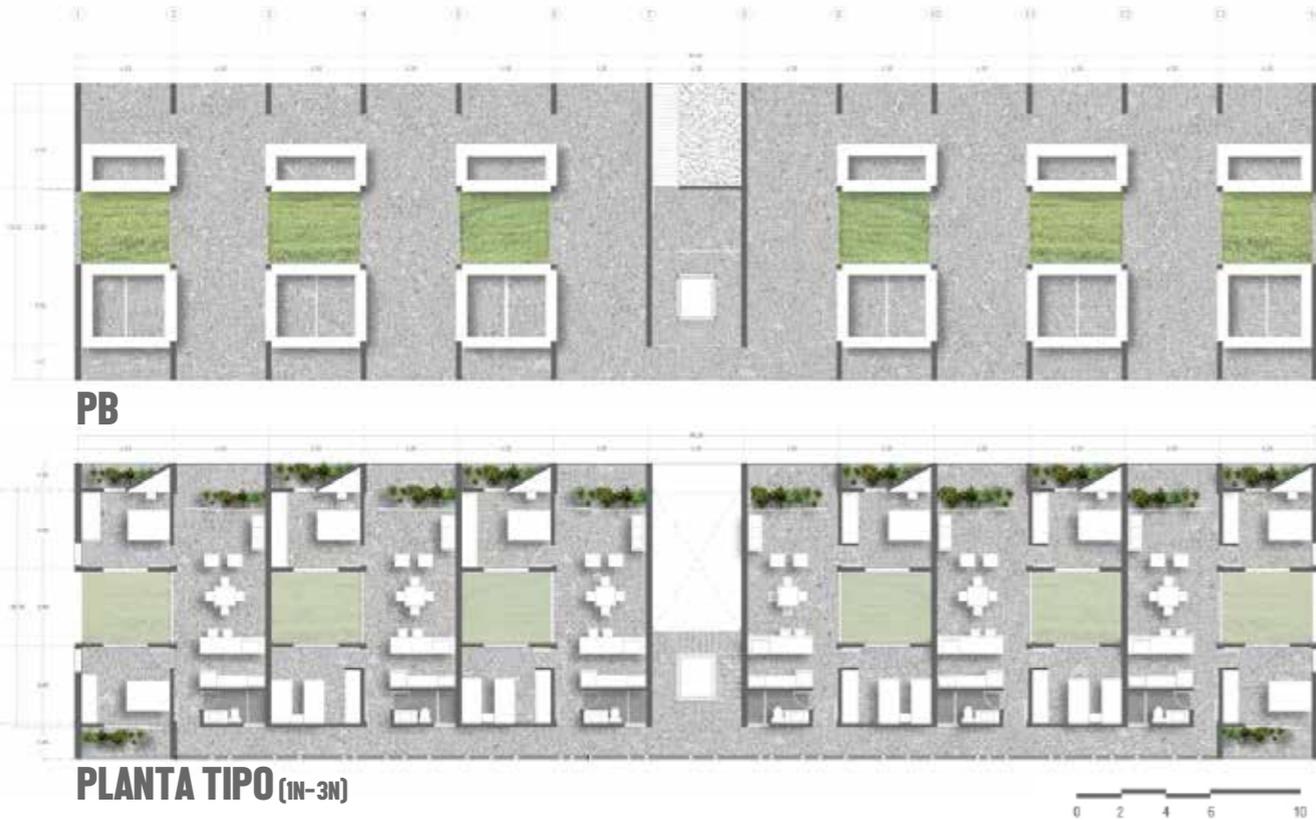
"Plantas arquitectónicas Edificio M1".
